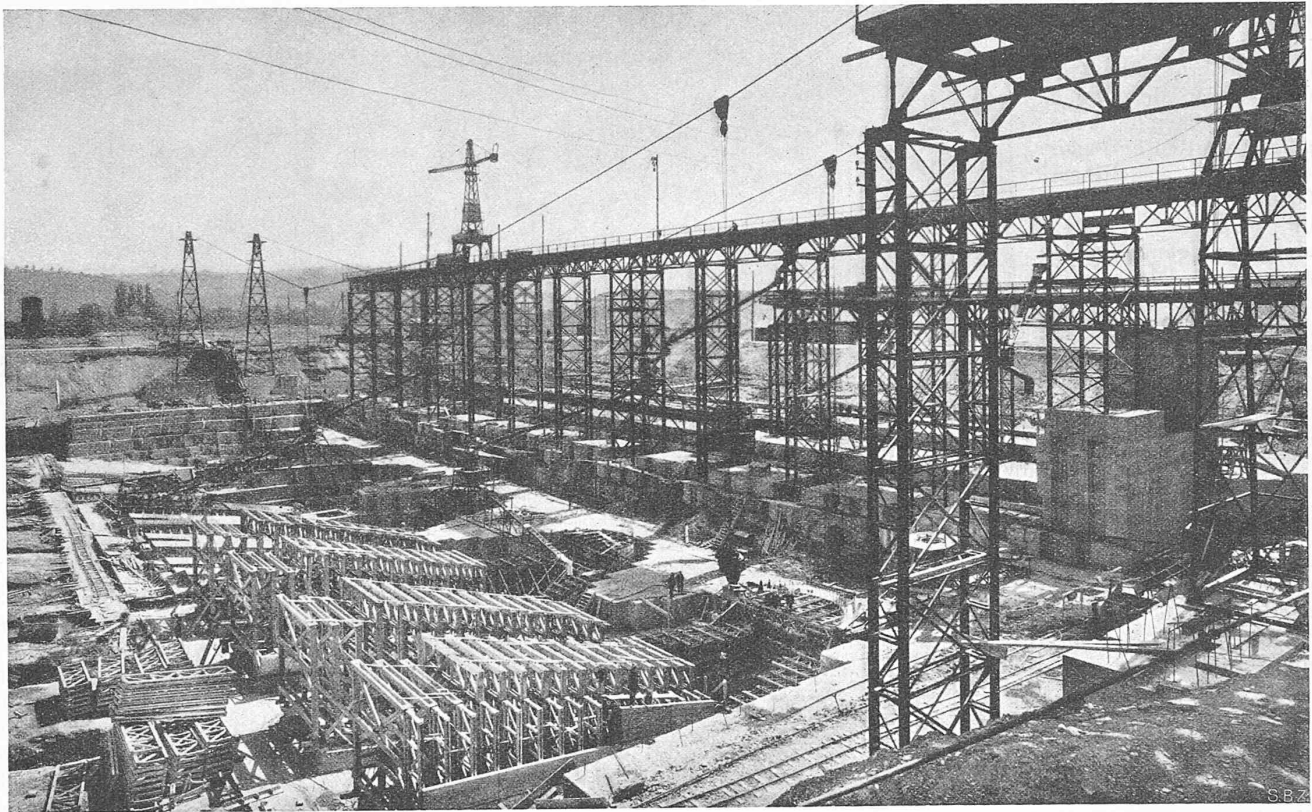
Gussbeton-Anlage mit festen Stegen und fahrbarem Kabelkran auf der Maschinenhaus-Baustelle. — Bauzustand 17. Mai 1930.
